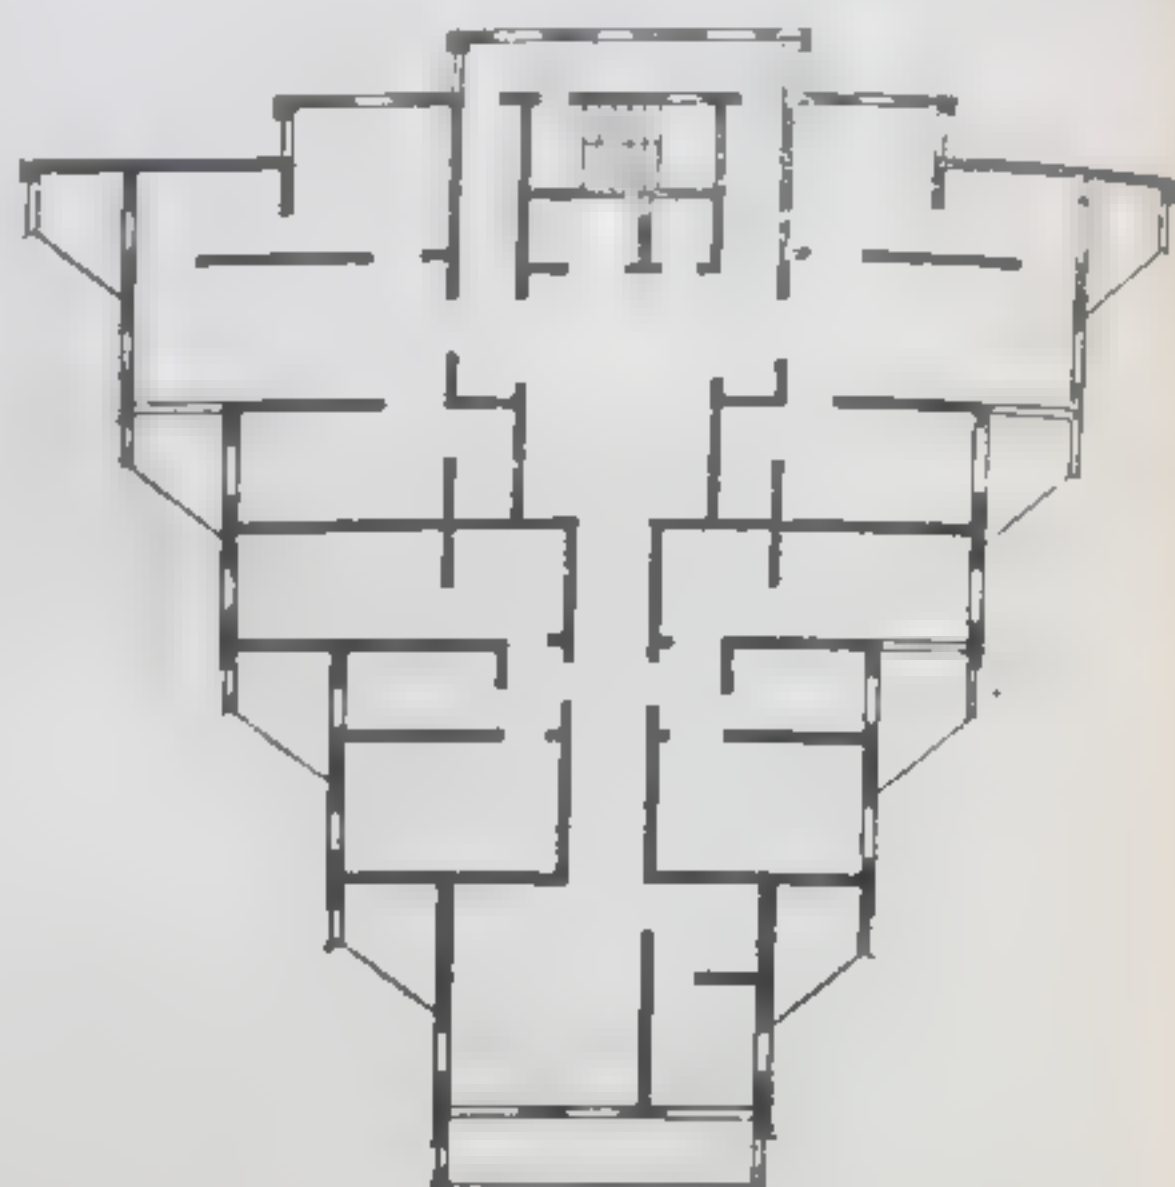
Схематический план здания с несущими стенами в обоих направлениях (16-этажный дом в Баку)
